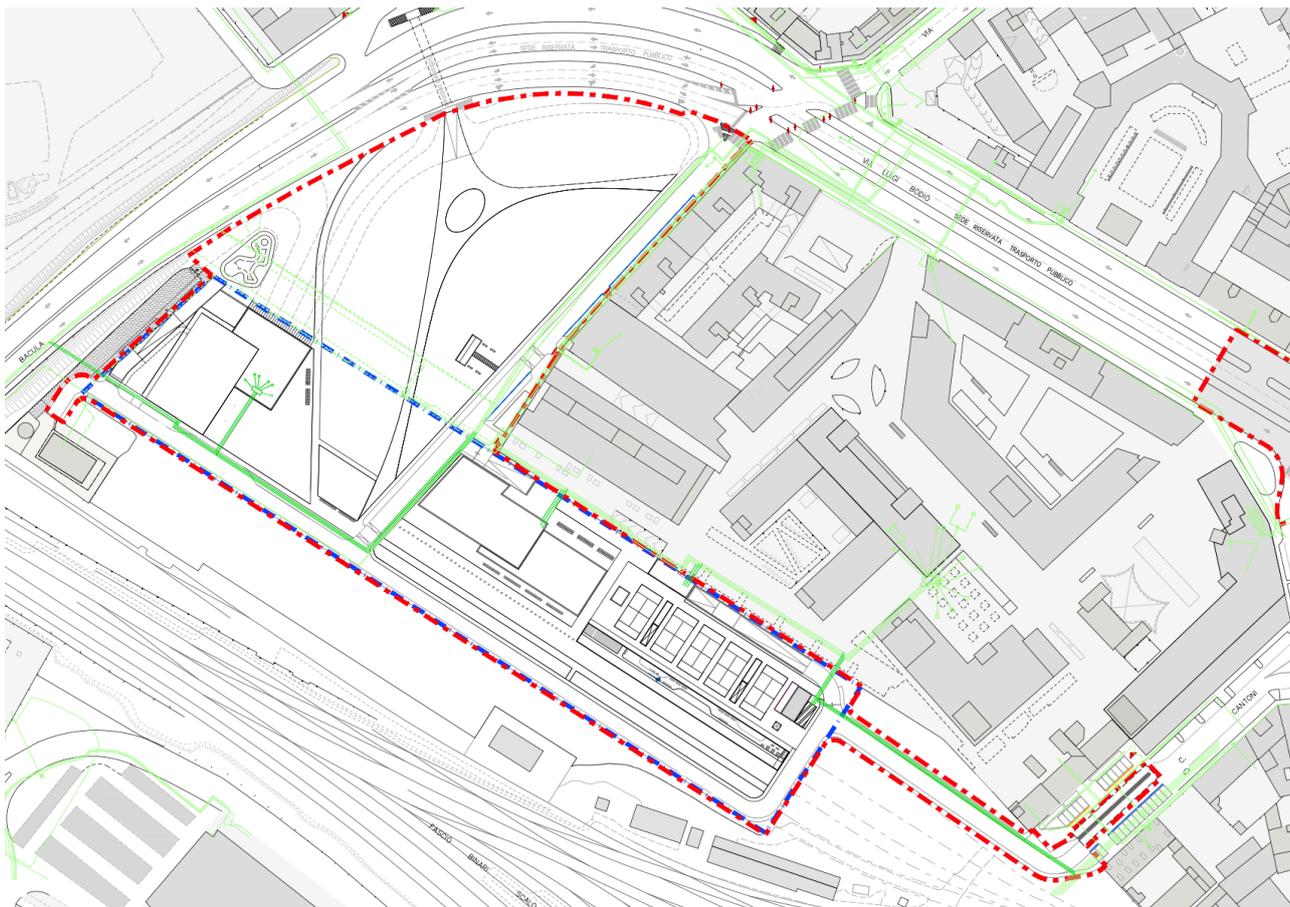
Rete elettrica MT – Planimetria (rif tav. 21IRM015-PP-SER-DR-E.03)
